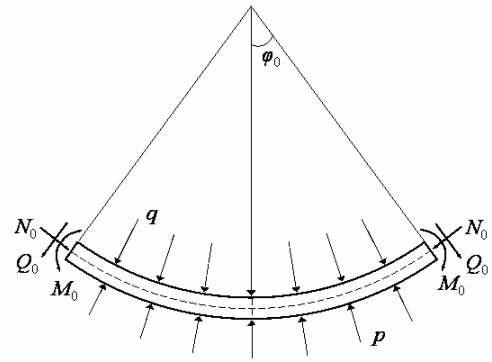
Розрахункова схема фрагмента циліндричної оболонки із пружною основою
